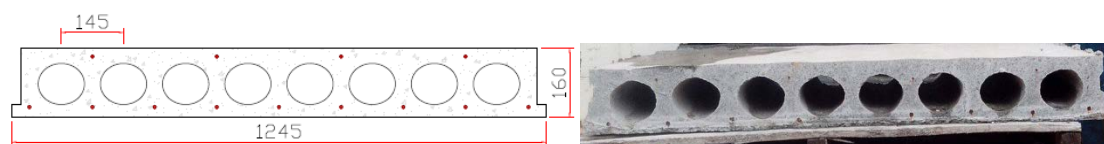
Dimensões da laje alveolar protendida (mm).
